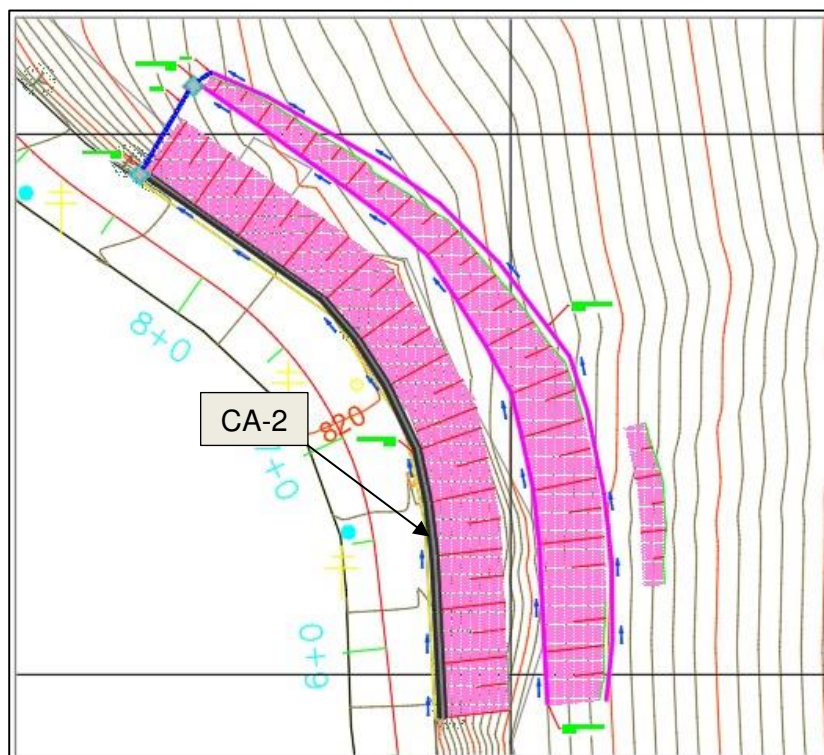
Arranjo Geral do Projeto com vista da cortina - CA-2 bem como da terraplenagem e drenagem superficial.
